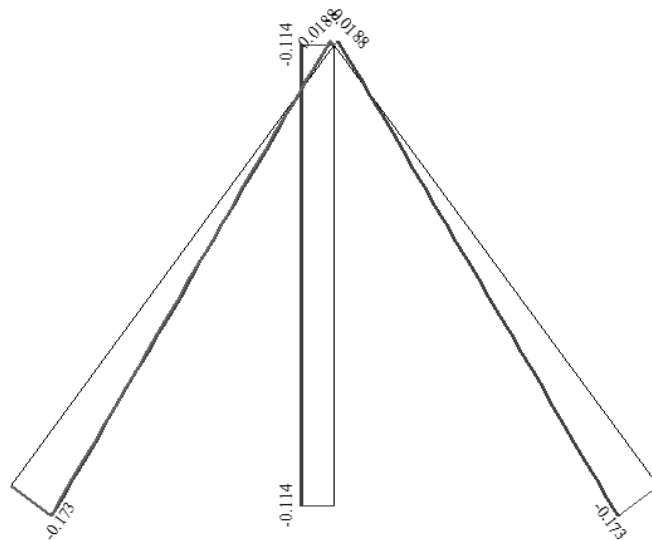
Эпюры N от загрузки №2 (нагрузка от конструкций кровли)
